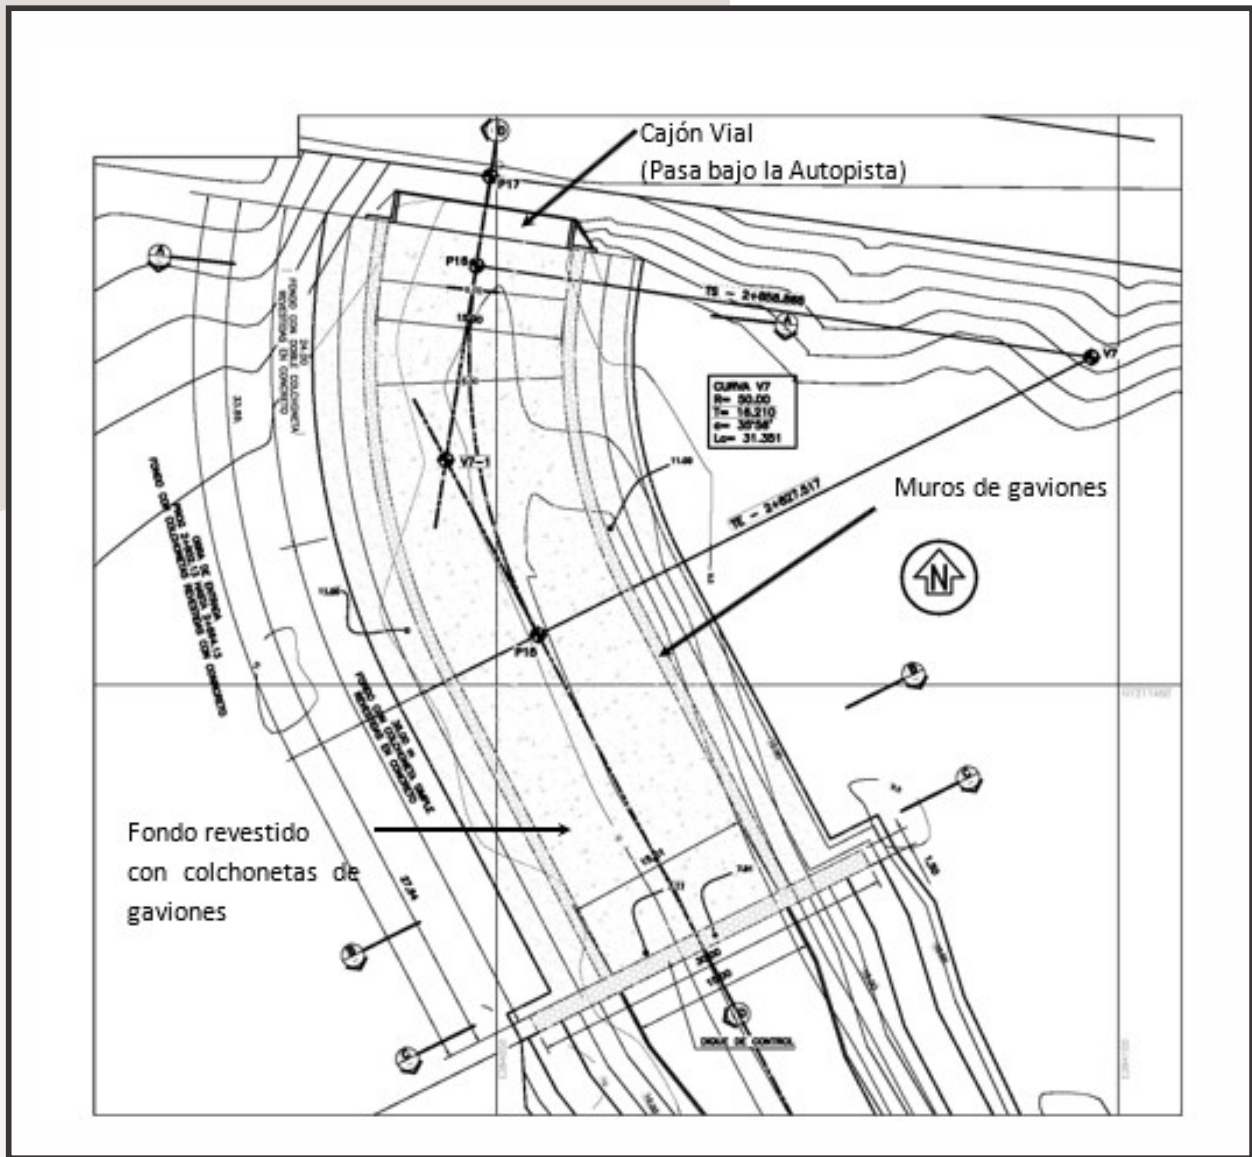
Canalización del río San Juan - Obra de Entrada – planta.
